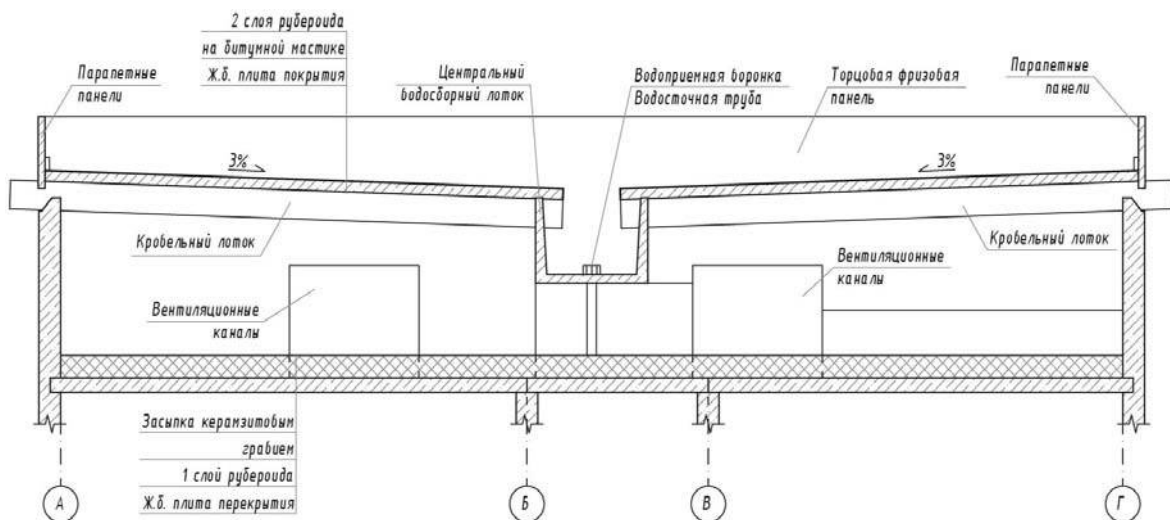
Конструктивное решение крыши крупнопанельных жилых зданий
